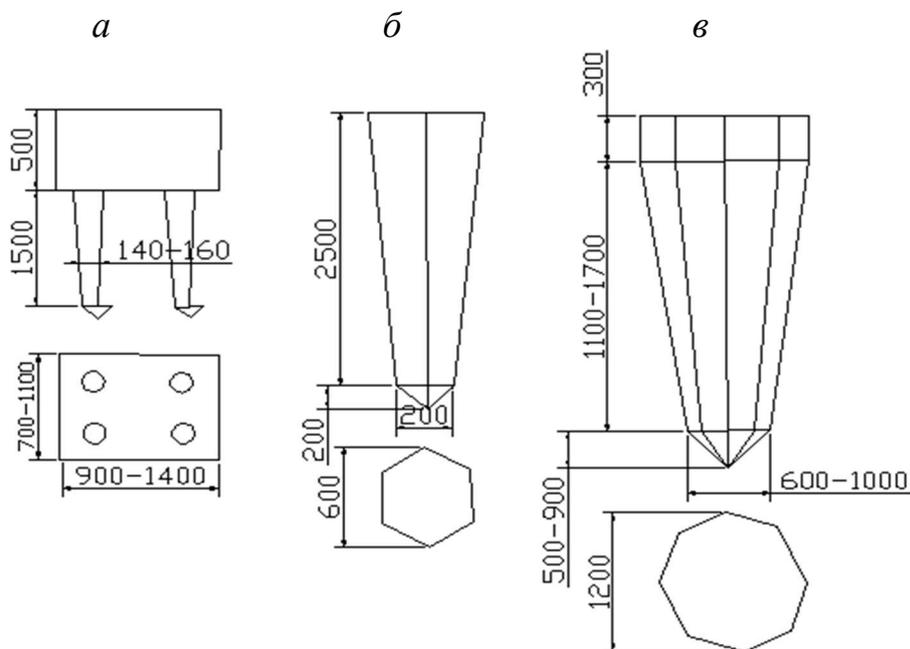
Виды набивных фундаментов с уплотненным основанием:
